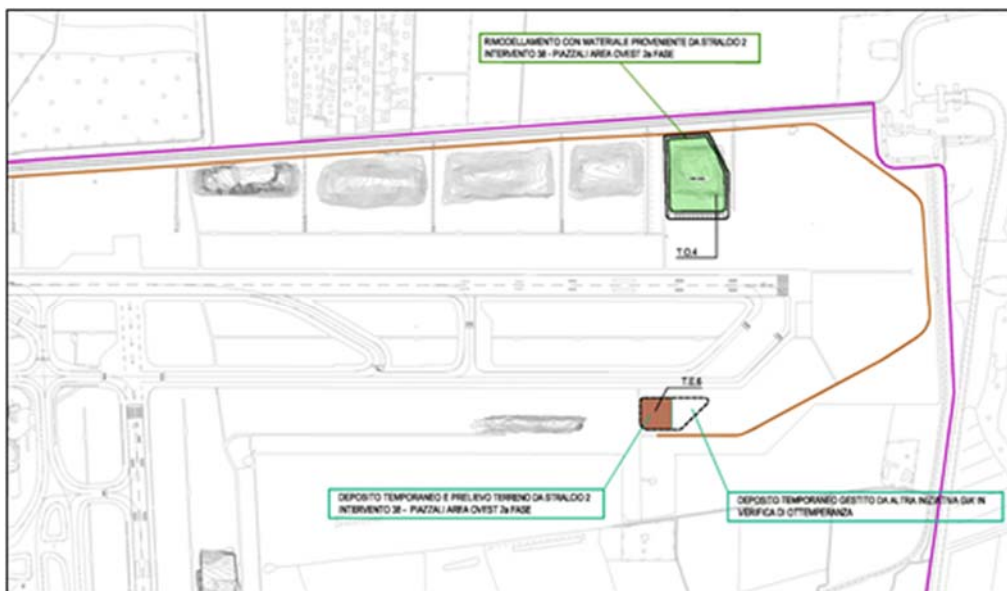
Stralcio planimetrico con l'evidenza del deposito provvisorio
